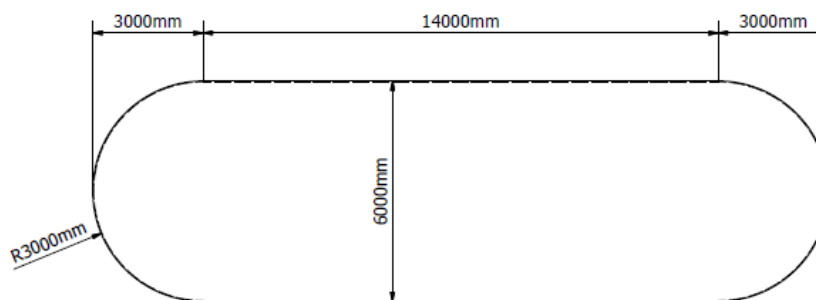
Gasômetros projetados da planta de biodigestão.
